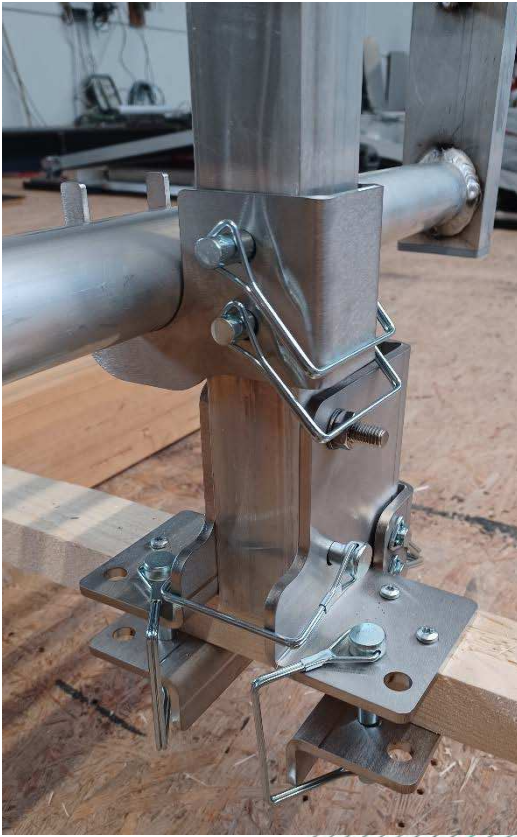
montant et sous-groupe de montant Photo 3 : goupille rabattable
